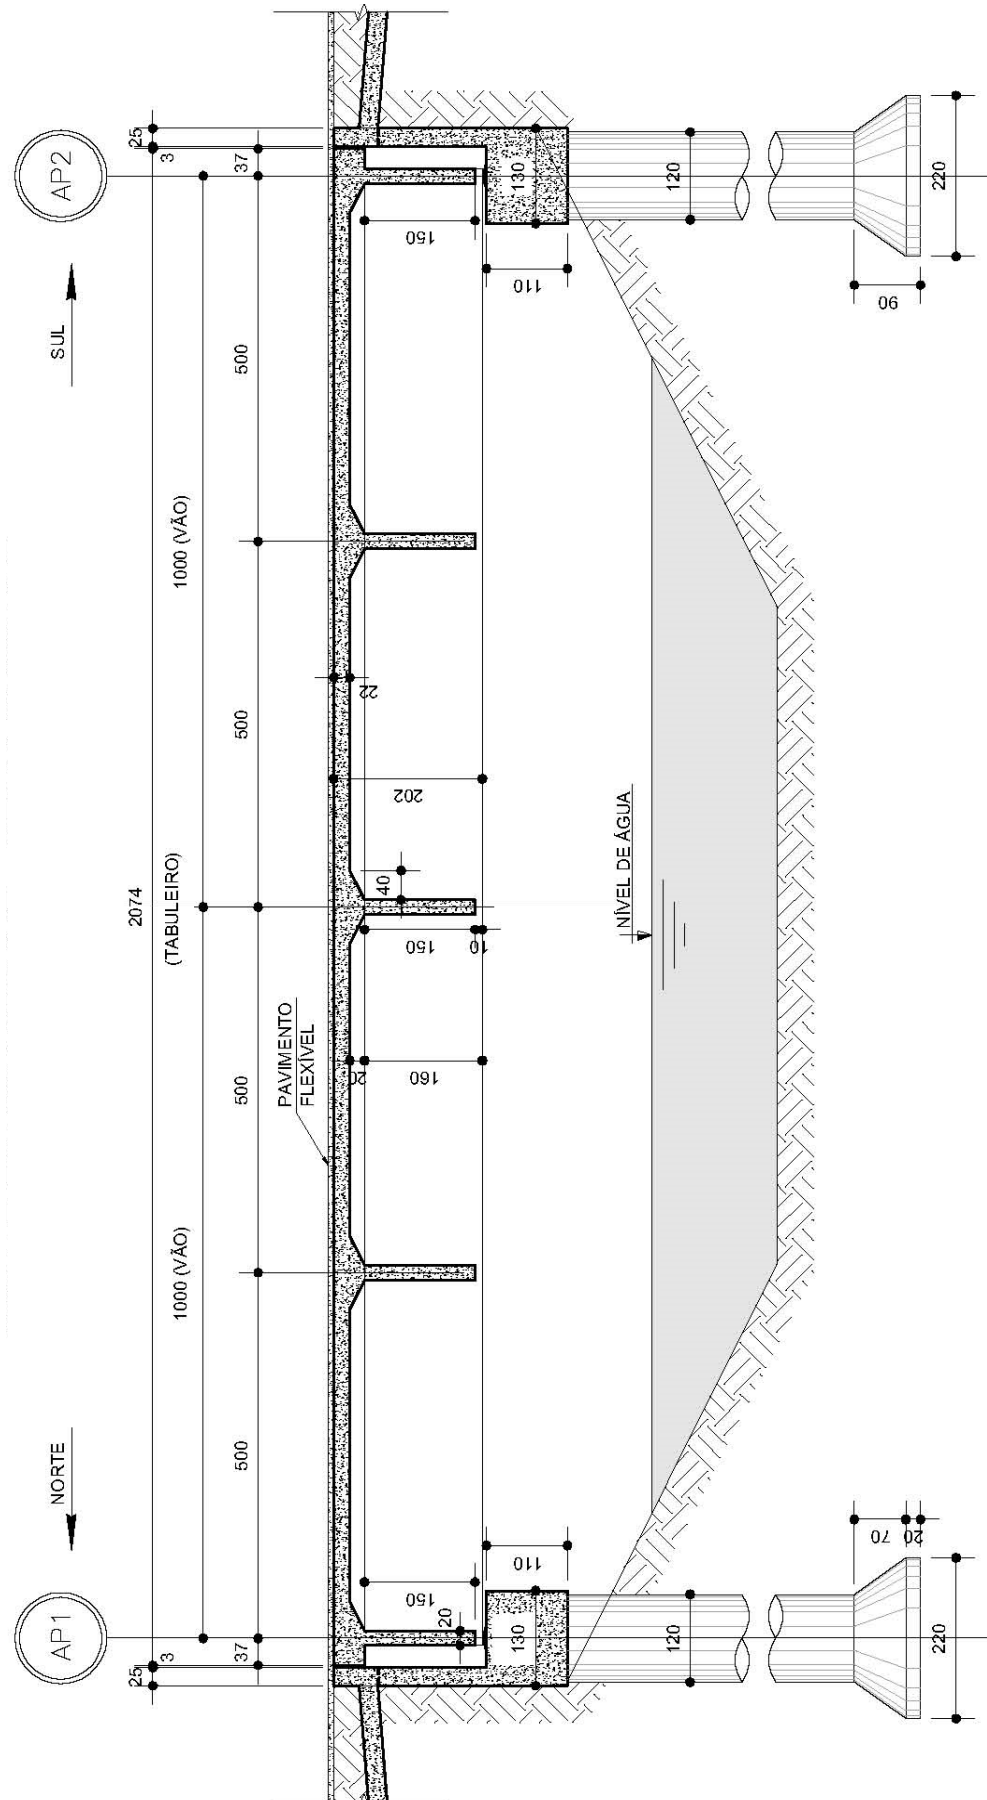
Corte longitudinal da obra original (medidas em cm)
